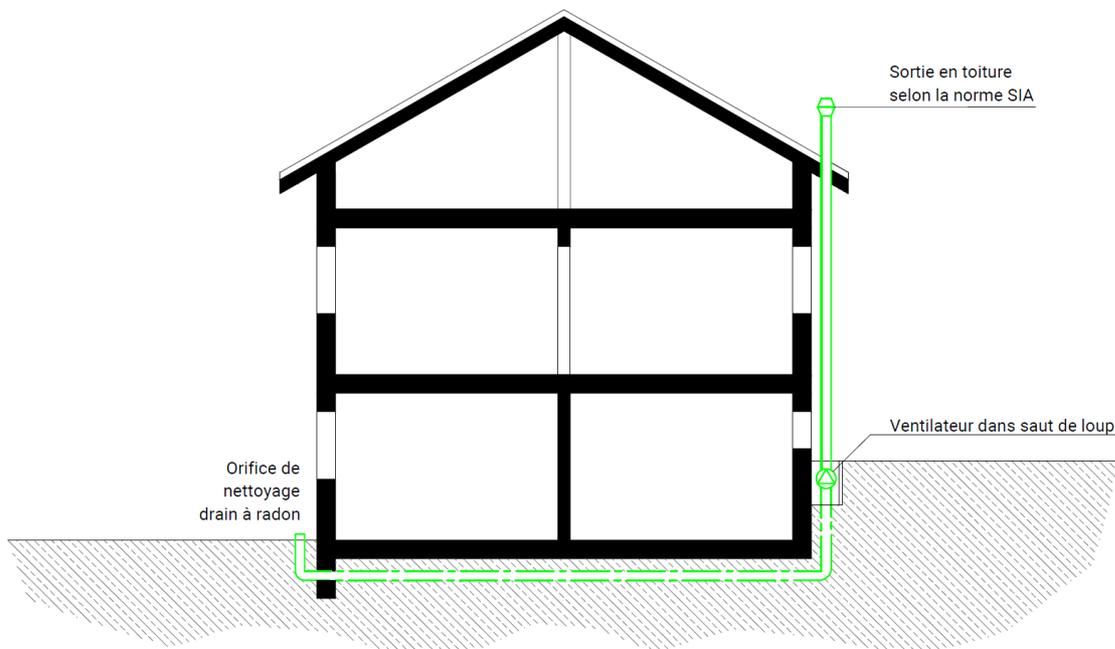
Coupe de principe d'un drainage sous radier avec ventilateur en toiture selon la norme SIA 382/1:2014 (détail : croqAIR, HEIA-FR)
